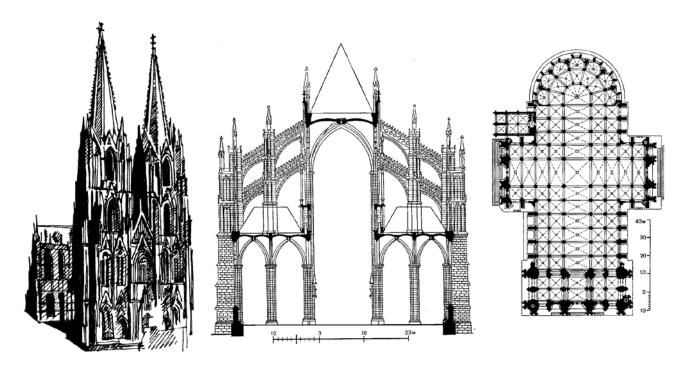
Кёльн. Собор (XIII–XIX вв.). Фасад. Разрез. План
